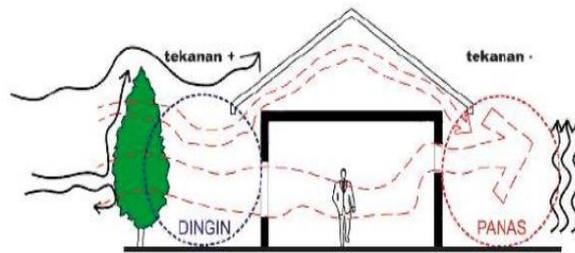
Ventilasi Alami Yang Baik Pada Bangunan.
